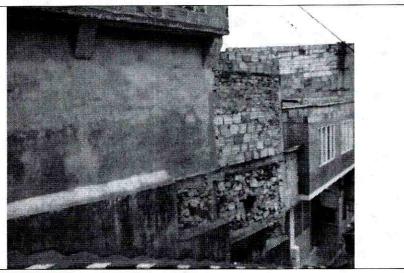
Se observa la conformación geométrica de las viviendas emplazadas en la Transversal 4C No. 50C -05 Sur, Calle 50C Sur No. 5-15 y Calle 50C Sur No. 5-17 sobre la ladera.
